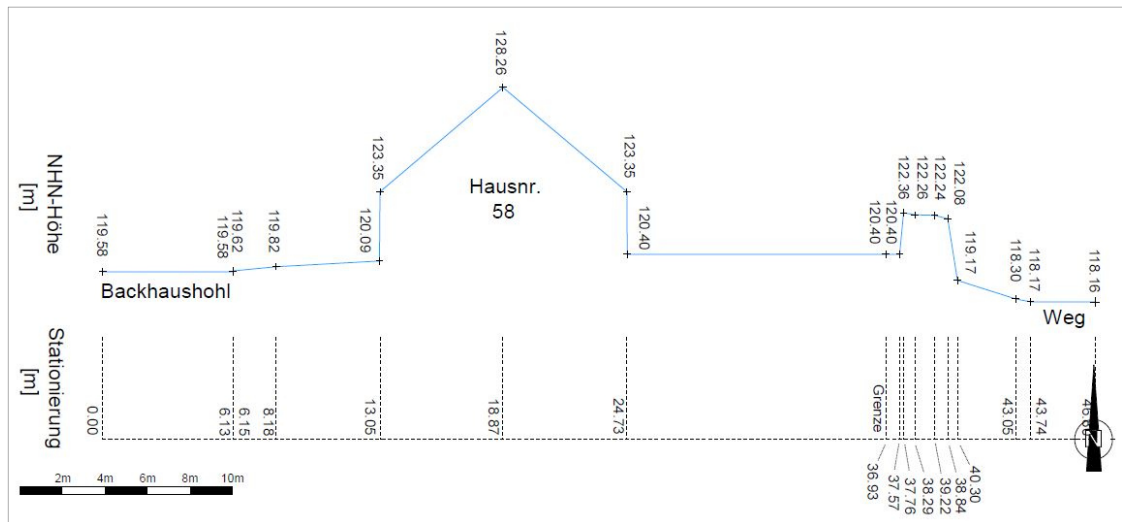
Geländeschnitt im WA 1, Backhaushohl 58, Stand Februar 2017
